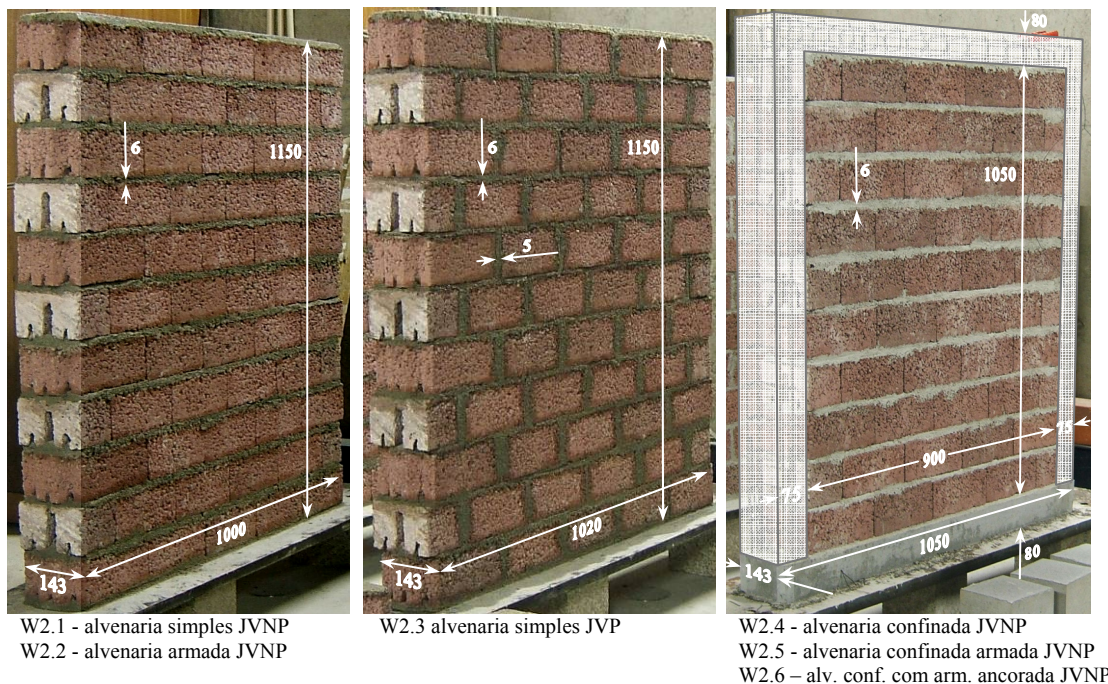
Tipos de paredes de blocos de betão leve submetidas a ensaio, e respectivas dimensões.
